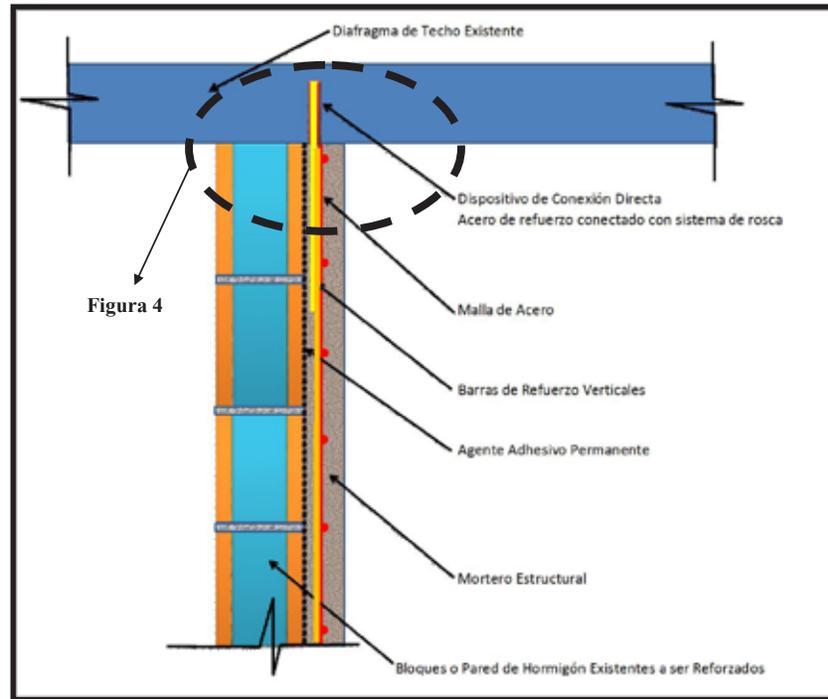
Detalle del Sistema de Malla de Acero con Mortero Estructural
